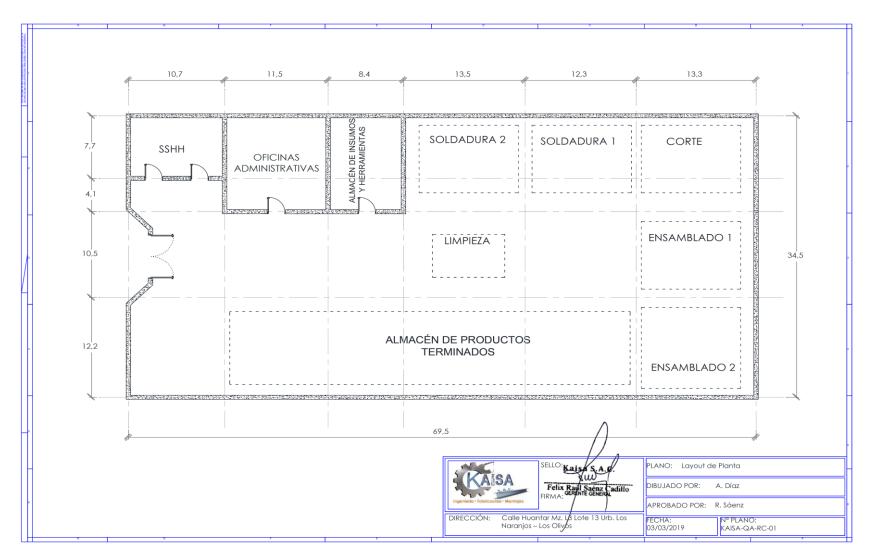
Layout de Planta de Kaisa S.A.C. Fuente: Elaboración Propia
